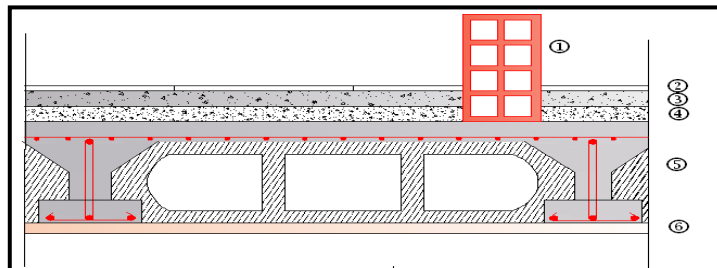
Coupe verticale du plancher d'étage courant.
